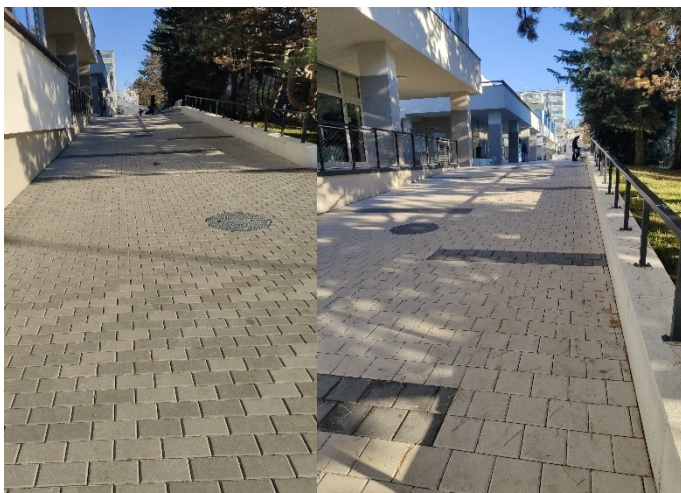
Návrh úpravy schodišťového prostoru před poštou
